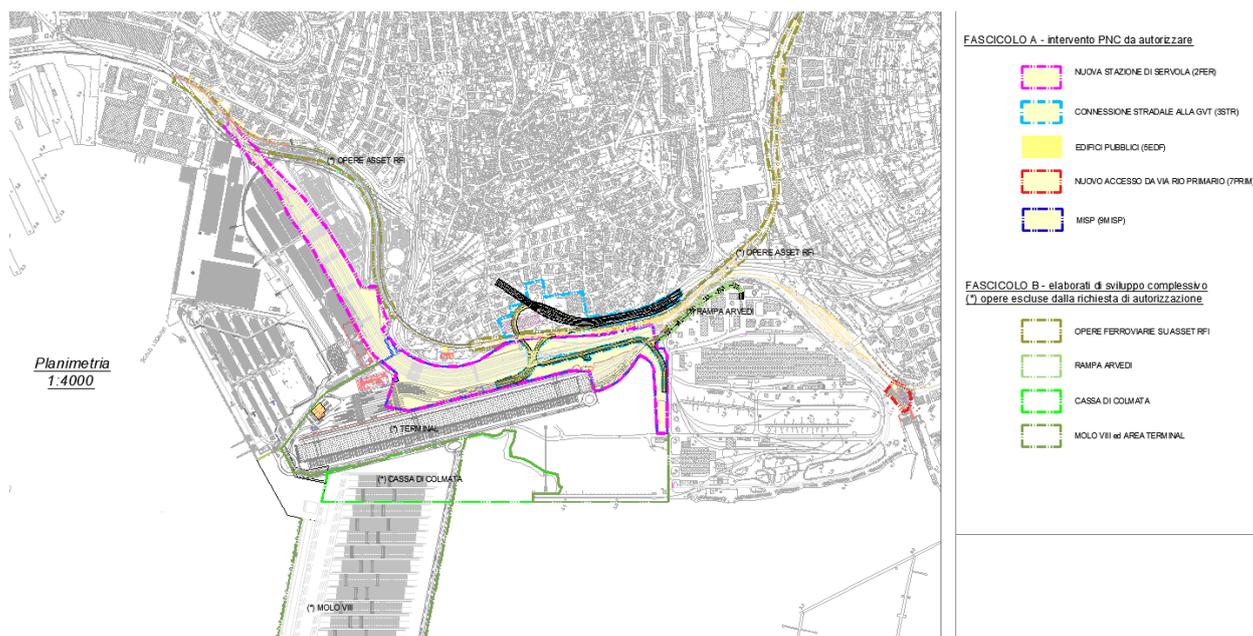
Planimetria delle opere del fascicolo A e del fascicolo B
